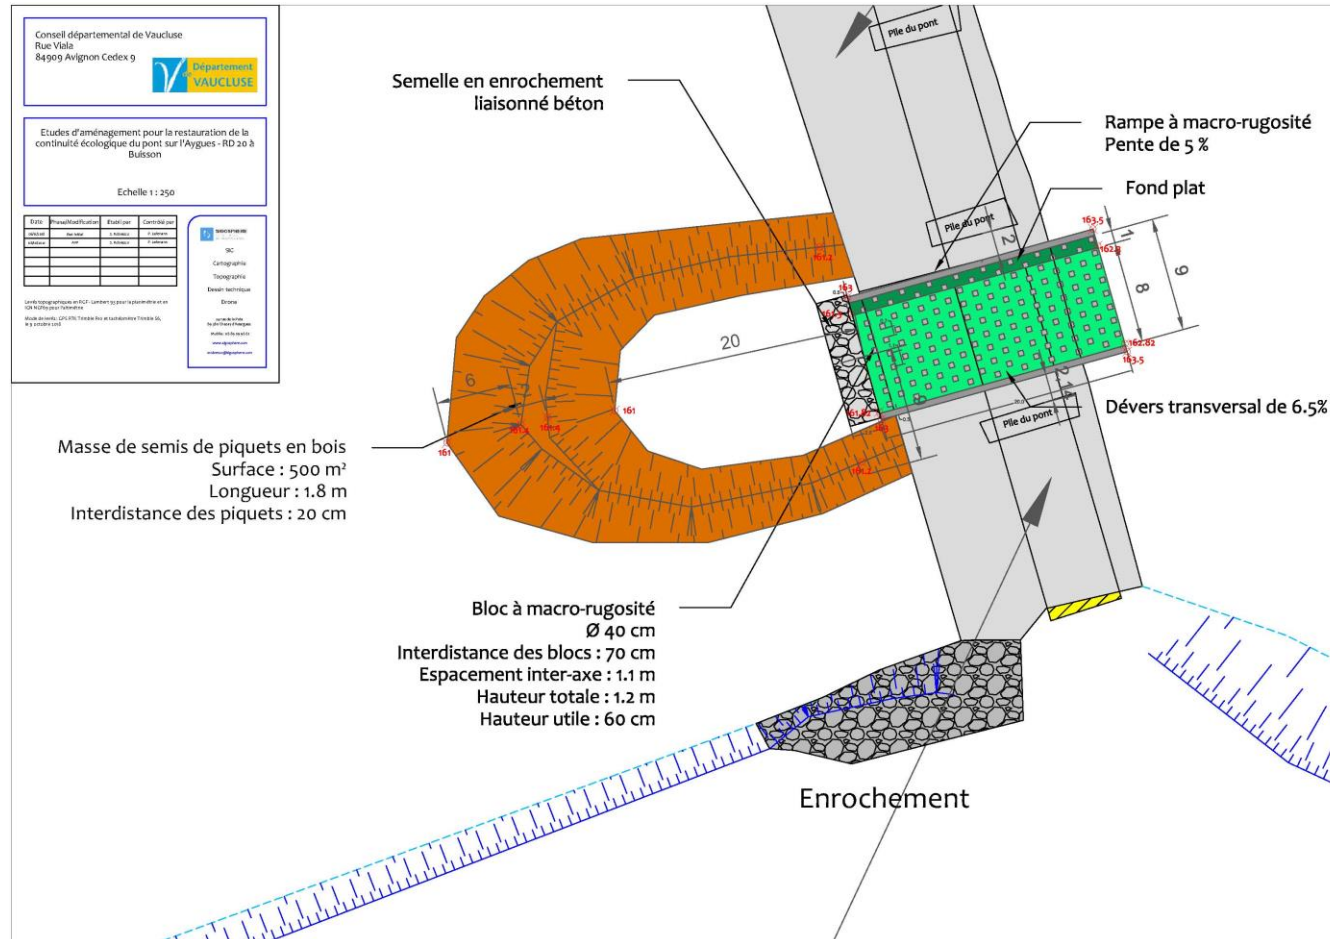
Extrait du plan de projet au droit du seuil de la RD20
